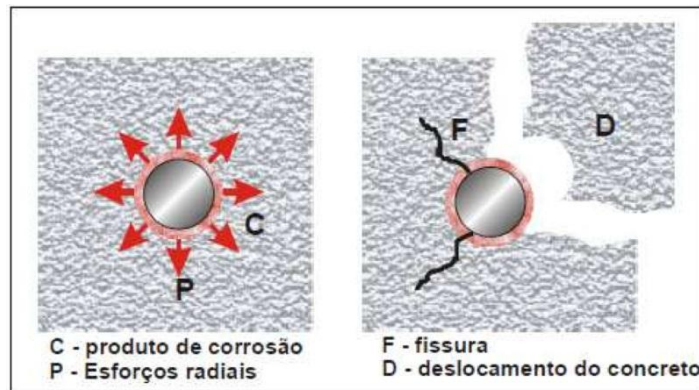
Processo degradante do concreto devido às tensões originadas da corrosão eletroquímica.
